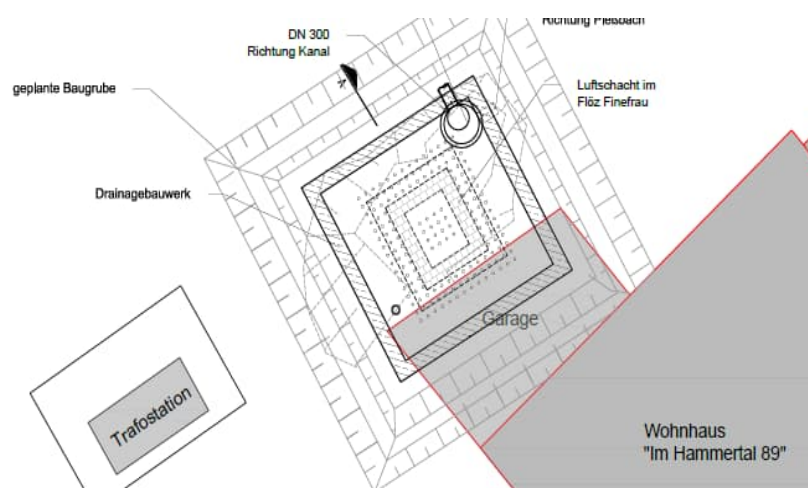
Geplante Lage Sicherungs- und Drainagebauwerk mit Baugrubenplanung
